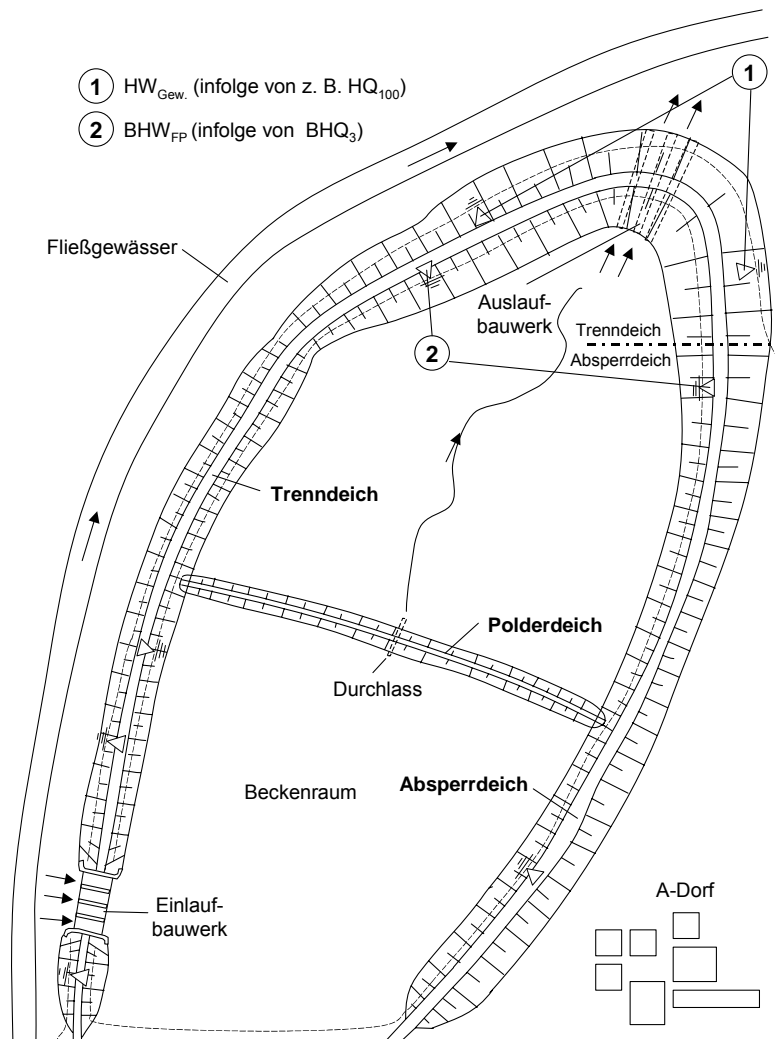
Skizzierter Lageplan eines Flutpolders mit Bauwerken
